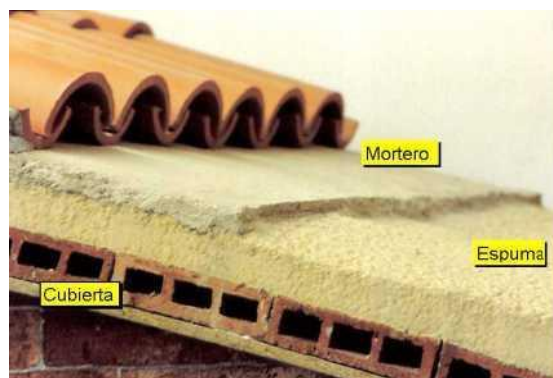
Aislamiento bajo teja con espuma de poliuretano proyectada.
